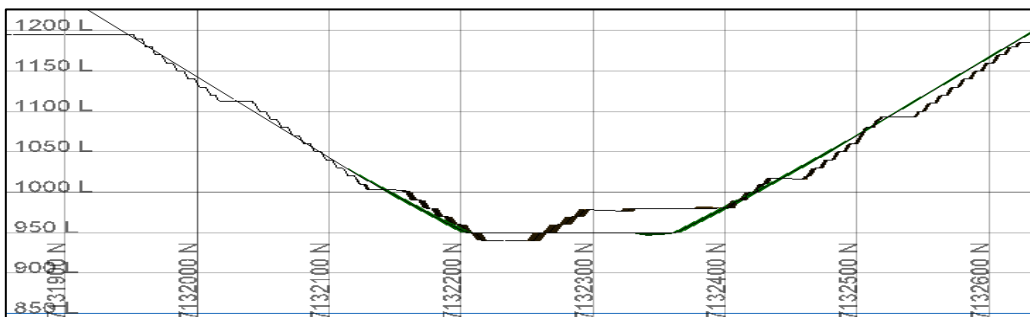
LGMM2Y Fase 2 - Vista en sección - Corte secundario N-S E394200
